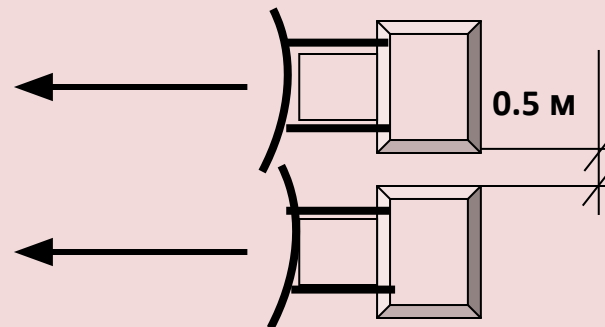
Перемещение грунта на расстояние до 40 м и спаренная работа двух бульдозеров
